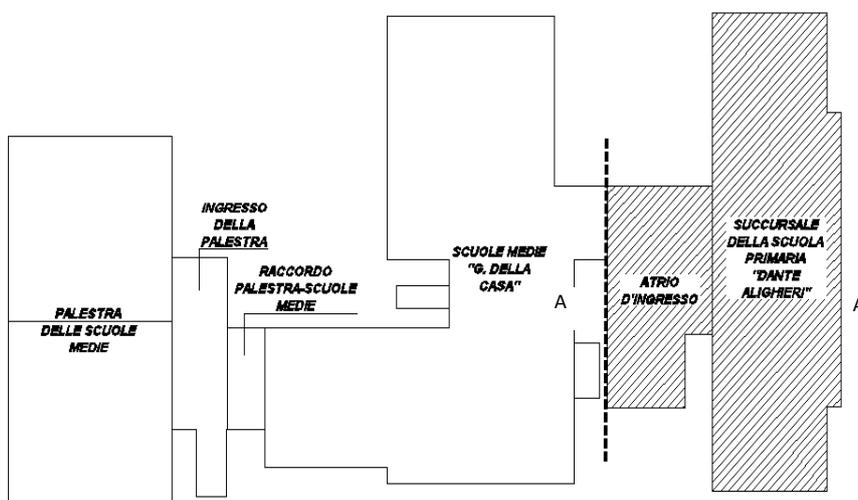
Complesso scolastico con l'indicazione dell'edificio in progetto
